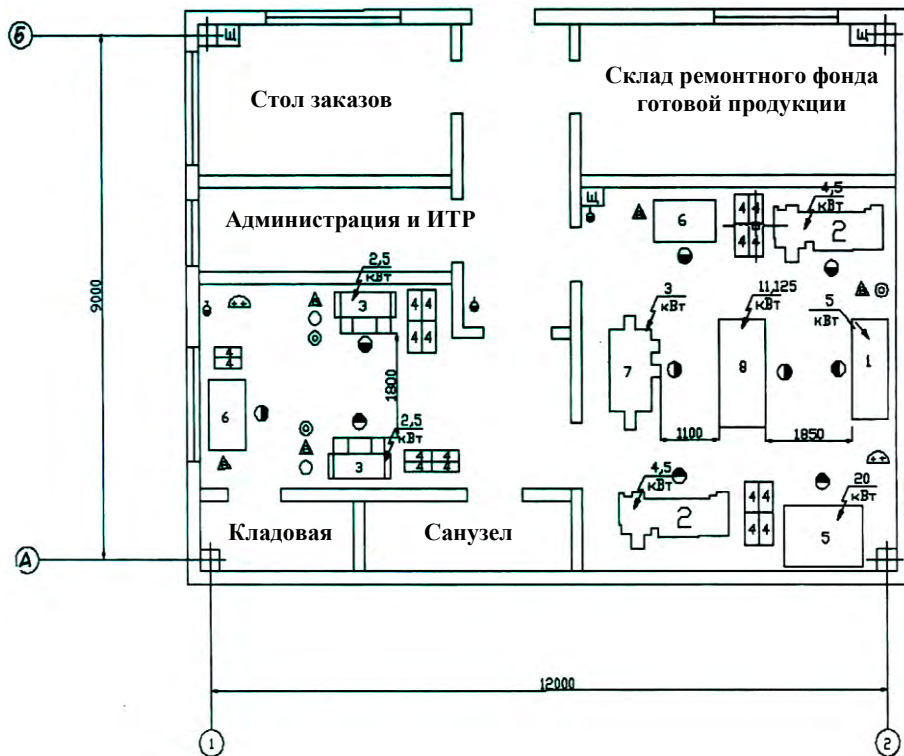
Планировка предприятия по восстановлению коленчатых валов двигателей газотермическим напылением:
